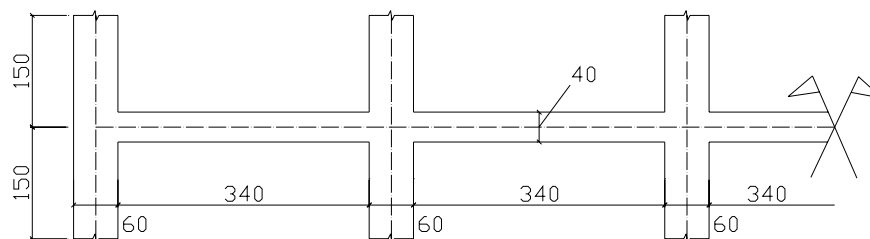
Geometria da viga, Caso 2 (dimensões em cm)
